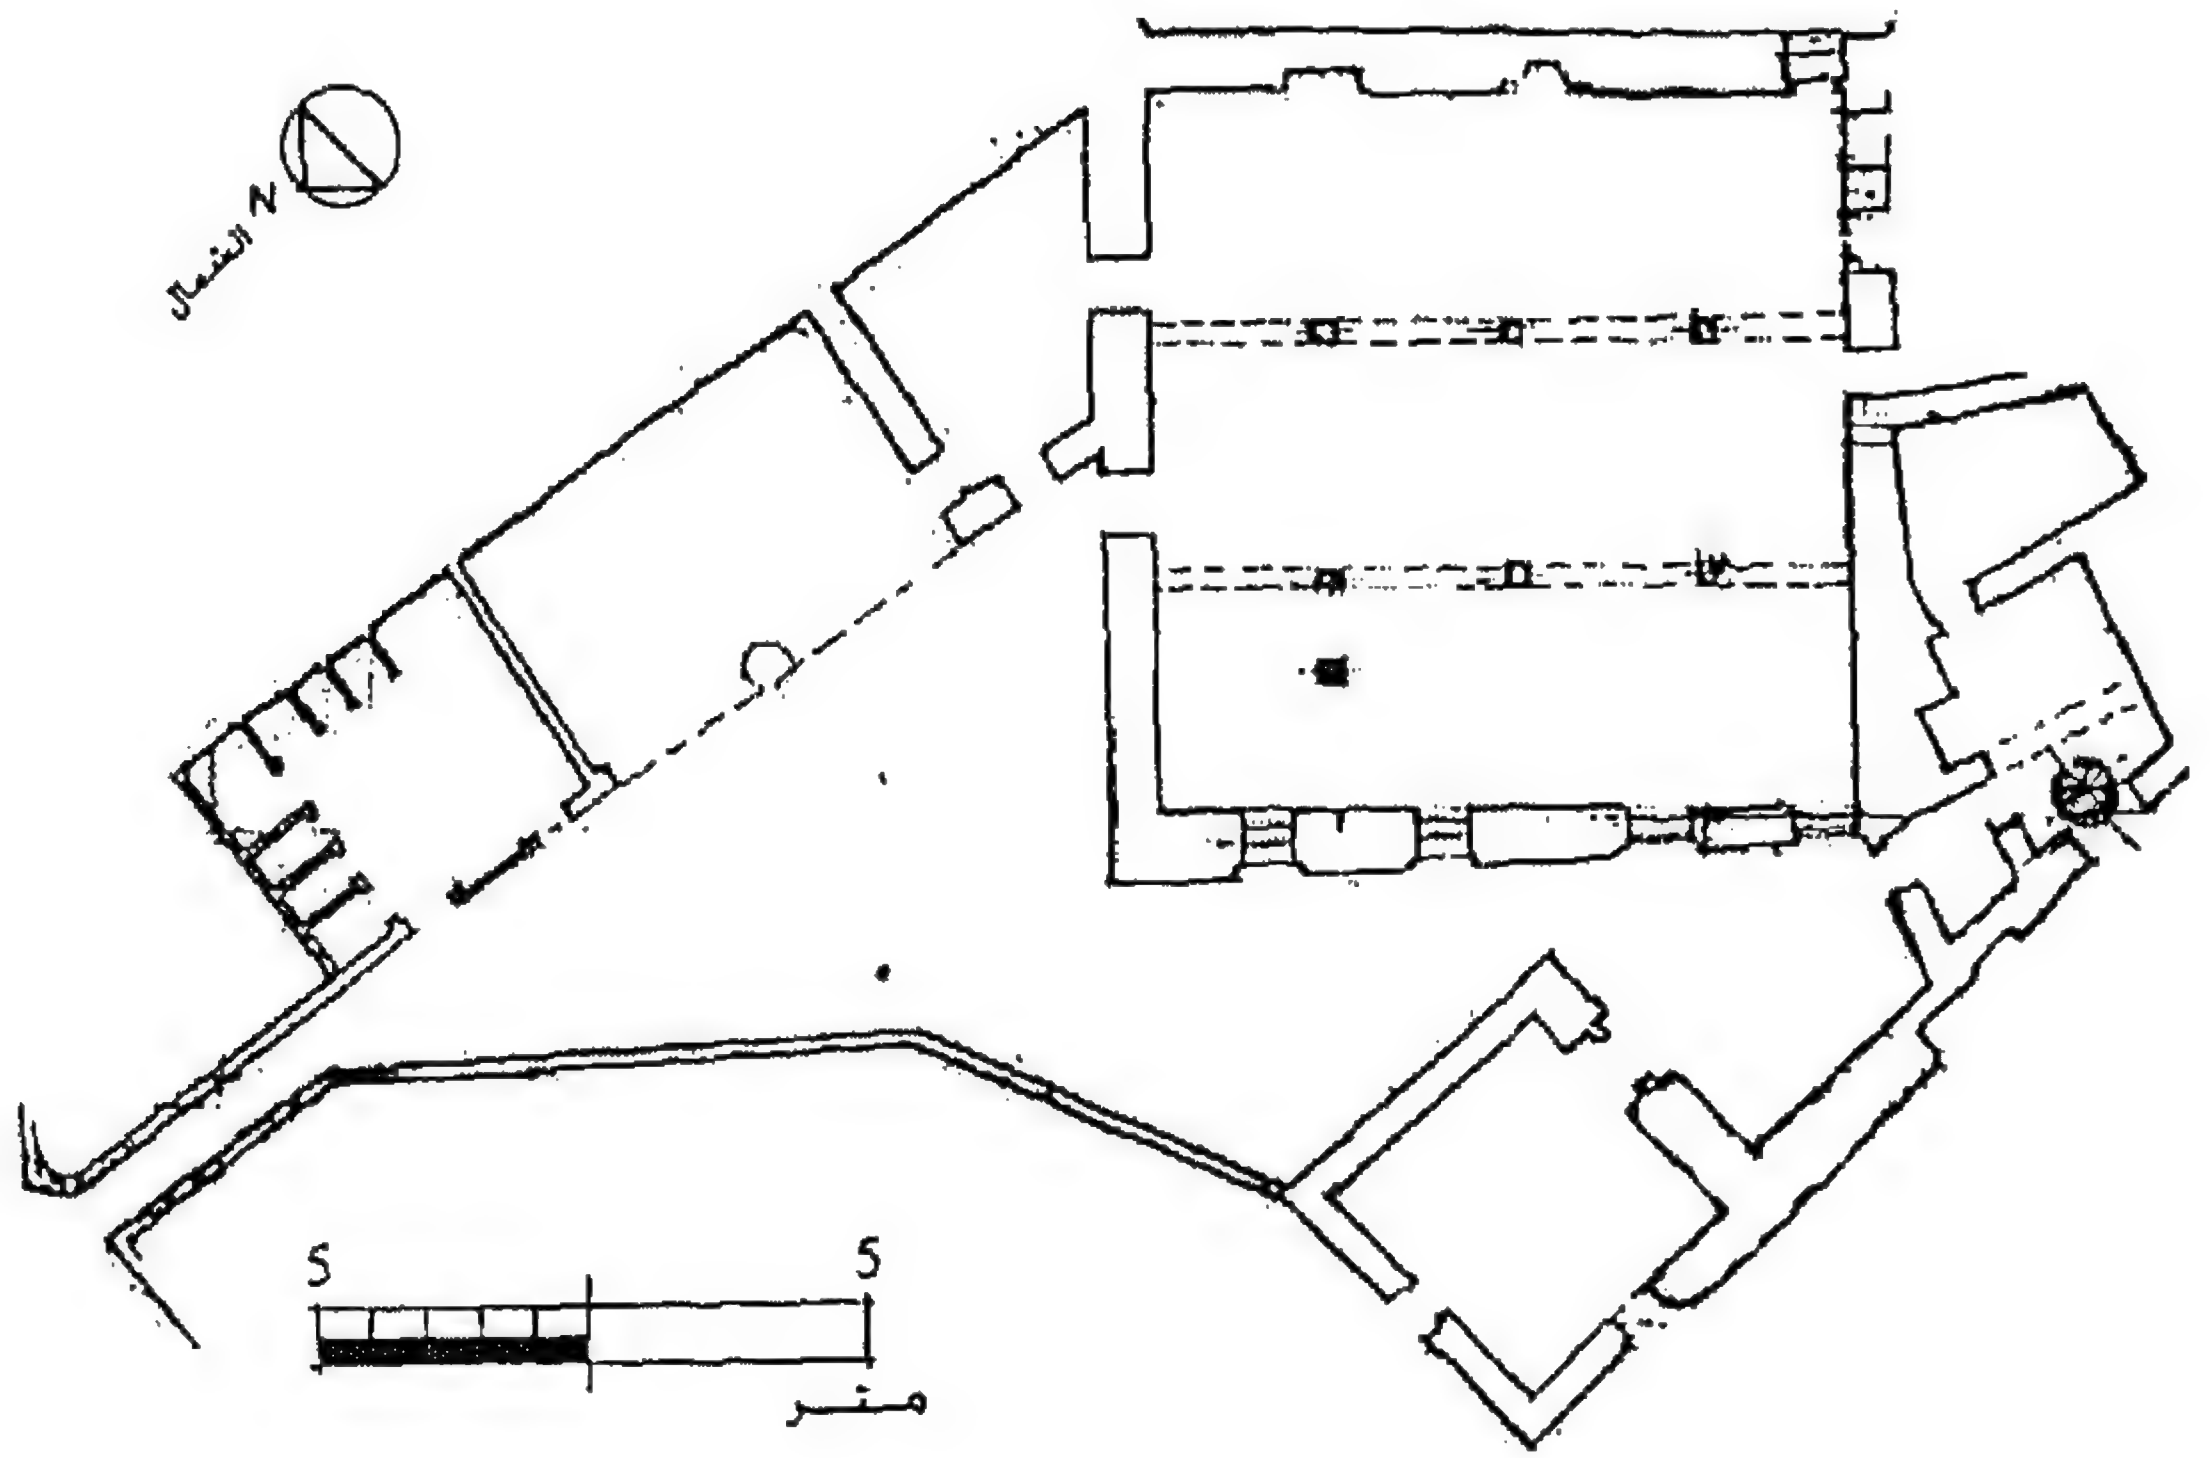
مسجد جوهر المعيني - مسقط
